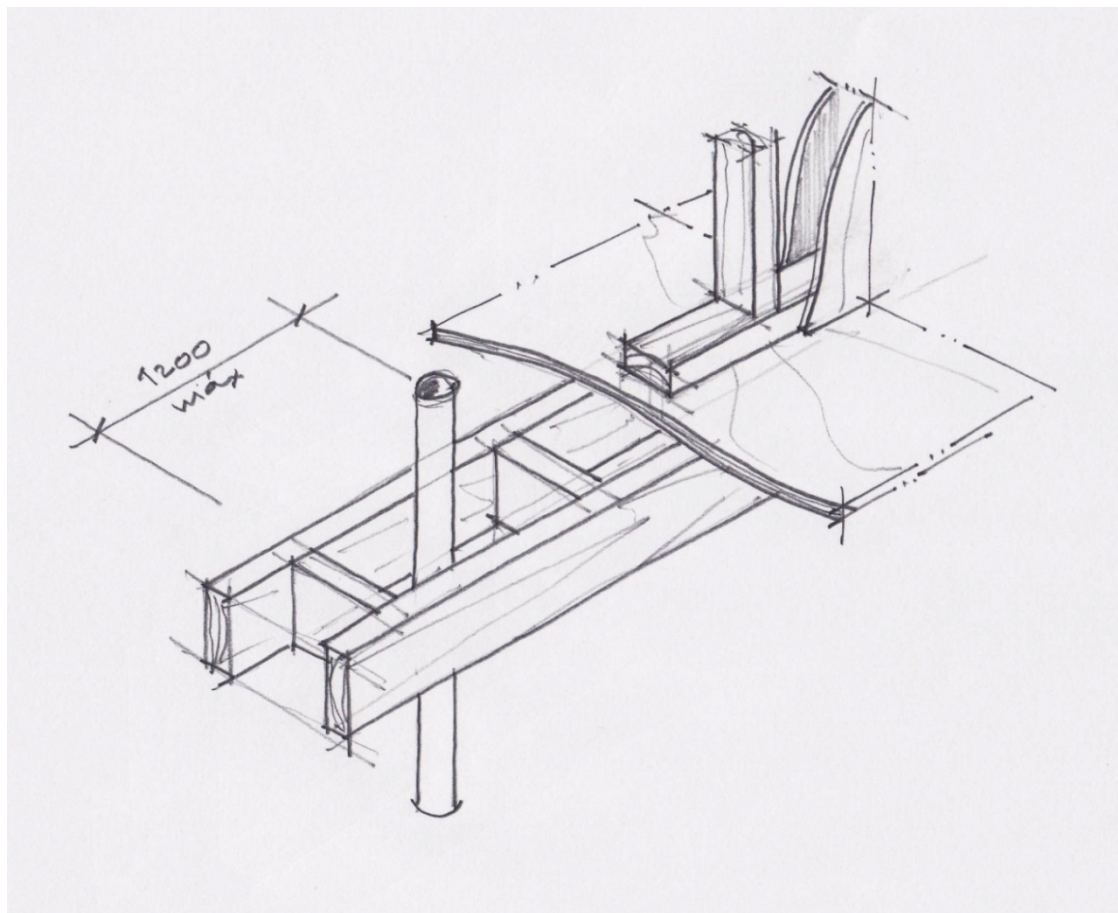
Armação de pavimento para passagem de infraestruturas. (des. autor)
